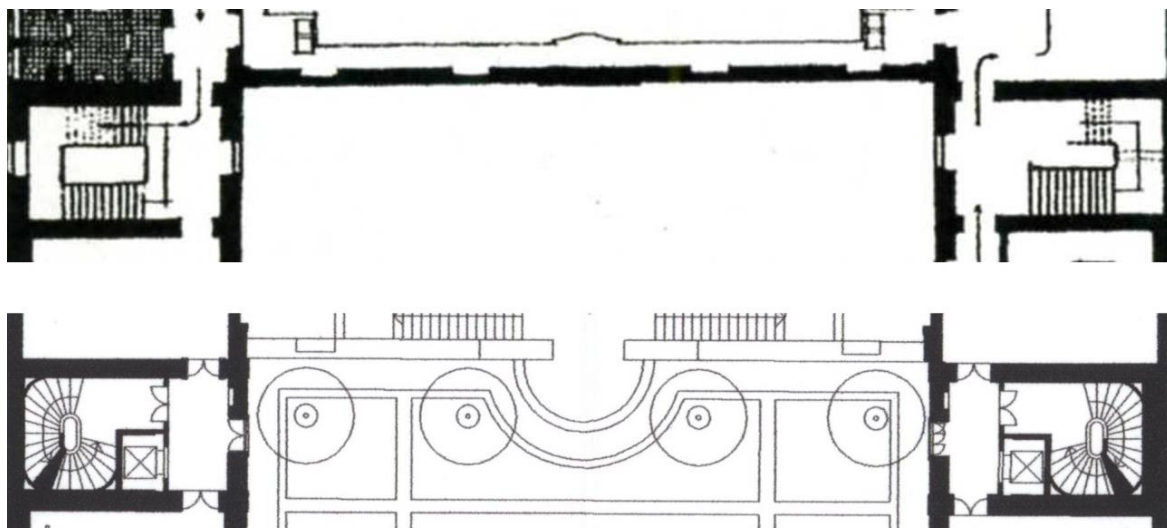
Colunas verticais de acesso antes da intervenção, 1º andar (superior); Colunas verticais de acesso após a intervenção, 1º andar (Inferior), 2013; Autora
